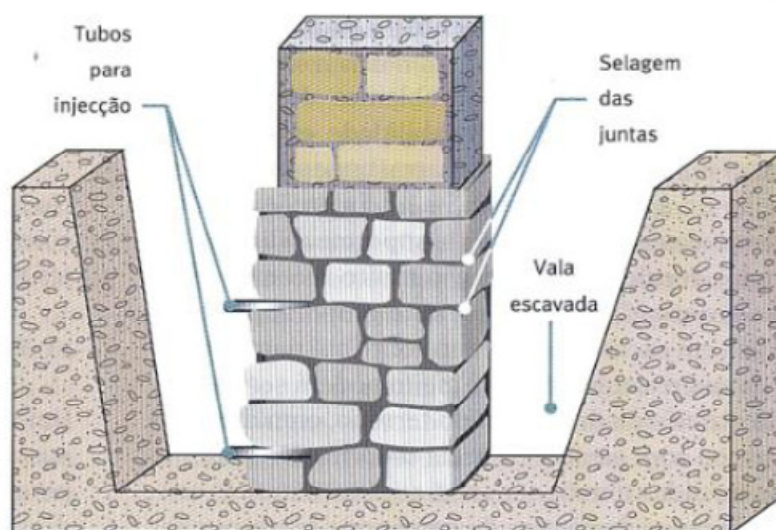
Injeção de calda de cimento ou resinas epoxídicas em juntas de alvenaria de fundações (Appleton, 2003)
